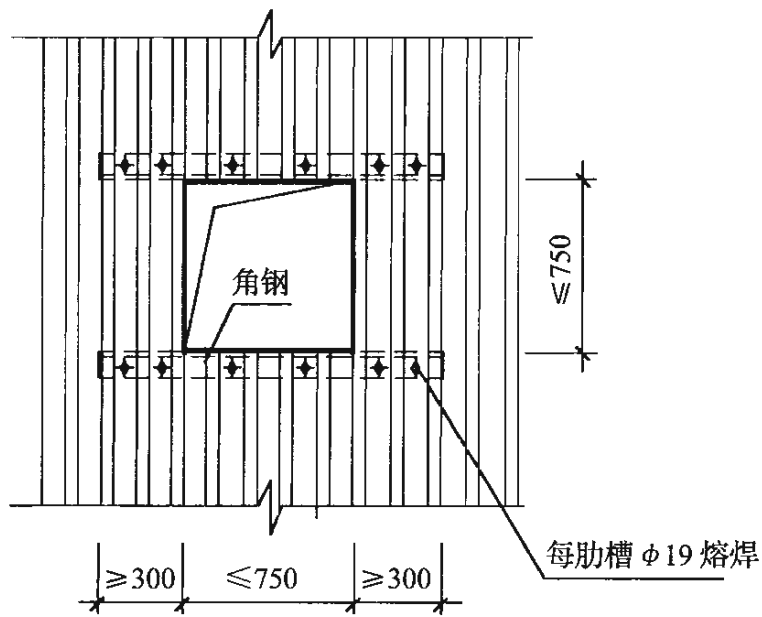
压型钢板开孔洞口加强示意图 (一)
